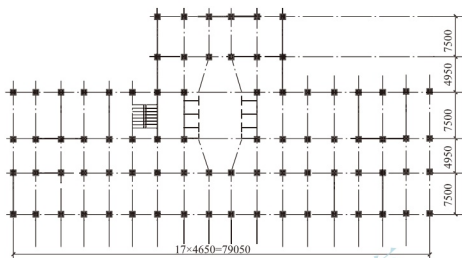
框架-剪力墙结构平面图（北京饭店新楼，18层）
